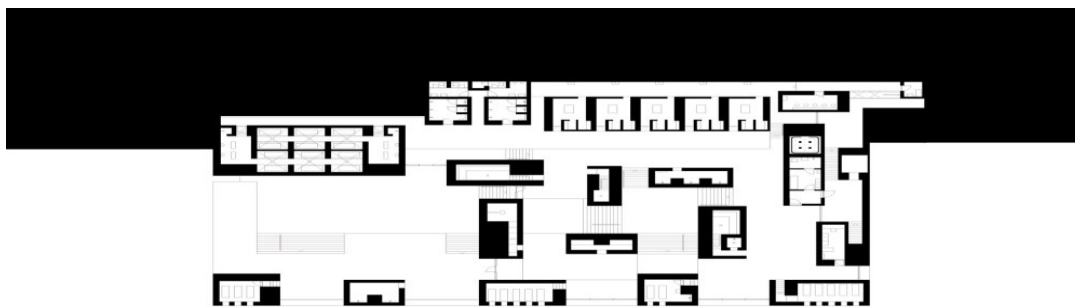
Planta do piso 1. (Fracalossi, 2011).
